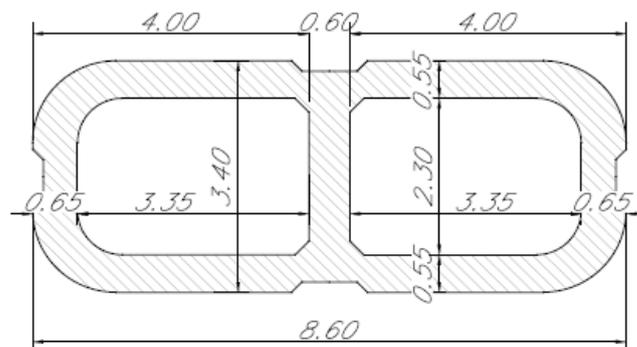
Sezione pila Bicellulare singolo binario 8.60m x 3.40m
